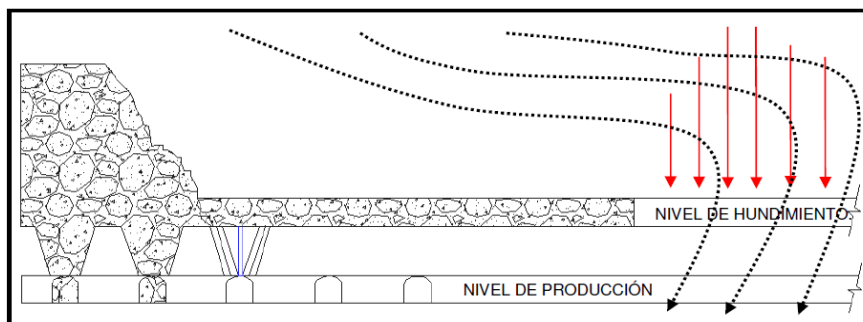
Vista longitudinal panel caving con hundimiento avanzado (Alvarez, 2009).
